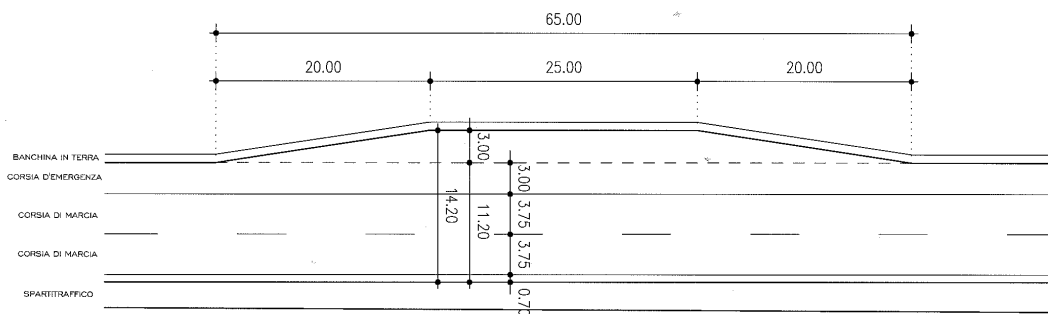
SCHEMA PLANIMETRICO DELLA PIAZZOLA DI SOSTA
